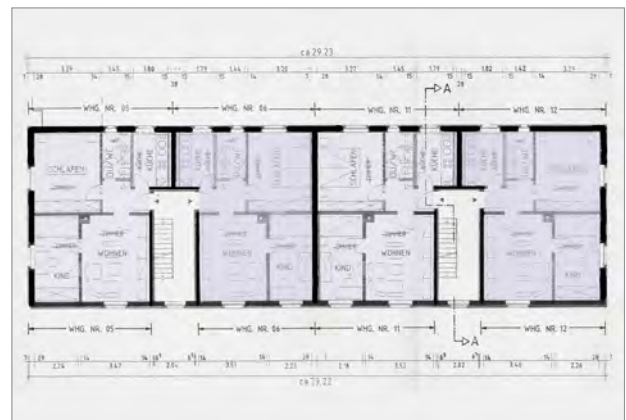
Beispiel Grundriss 3-Zi-Wohnungen
